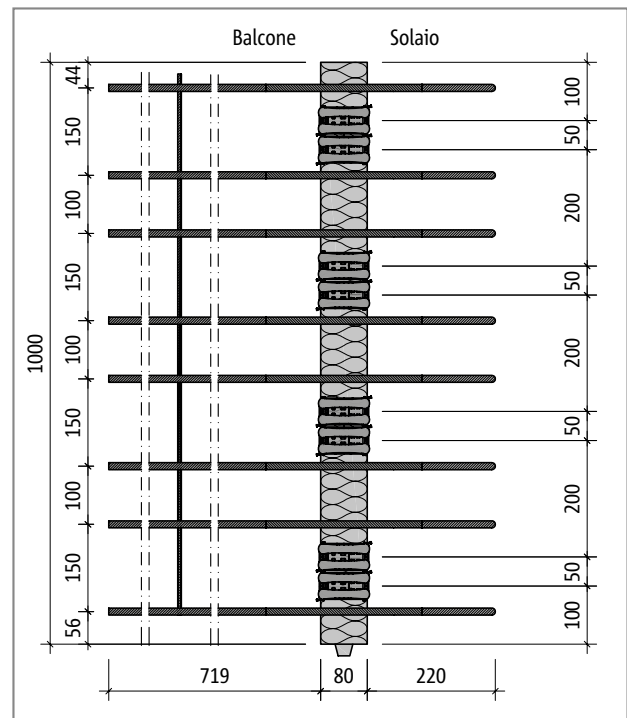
Schöck Isokorb® tipo Q60M: pianta del prodotto
